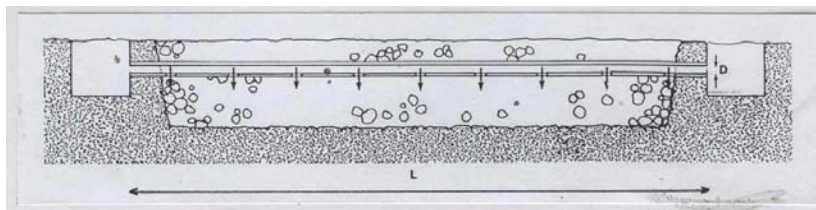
Tubería de reparto. D.- Diámetro, L.- Longitud.
